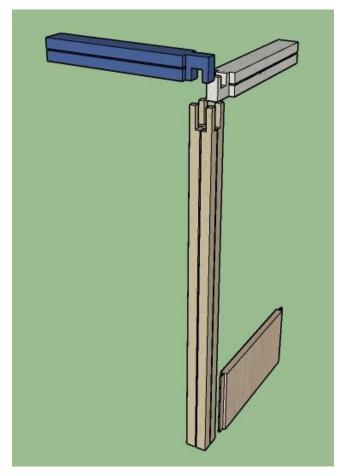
Unión en 3D de cómo se unen las vigas aéreas a la columna.
